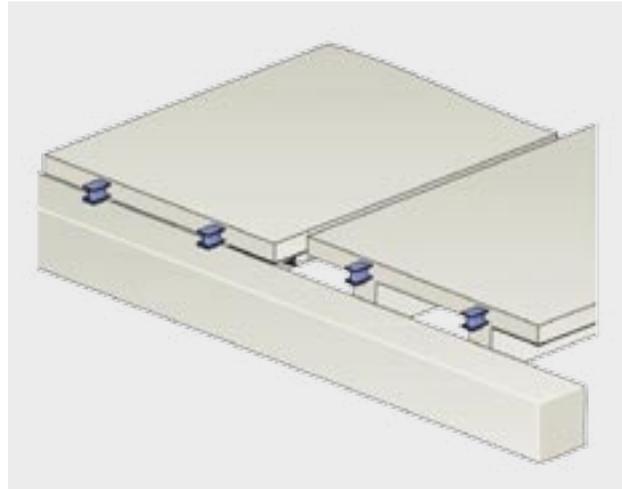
Auflager TT-Platten mit Stahlaufleger
